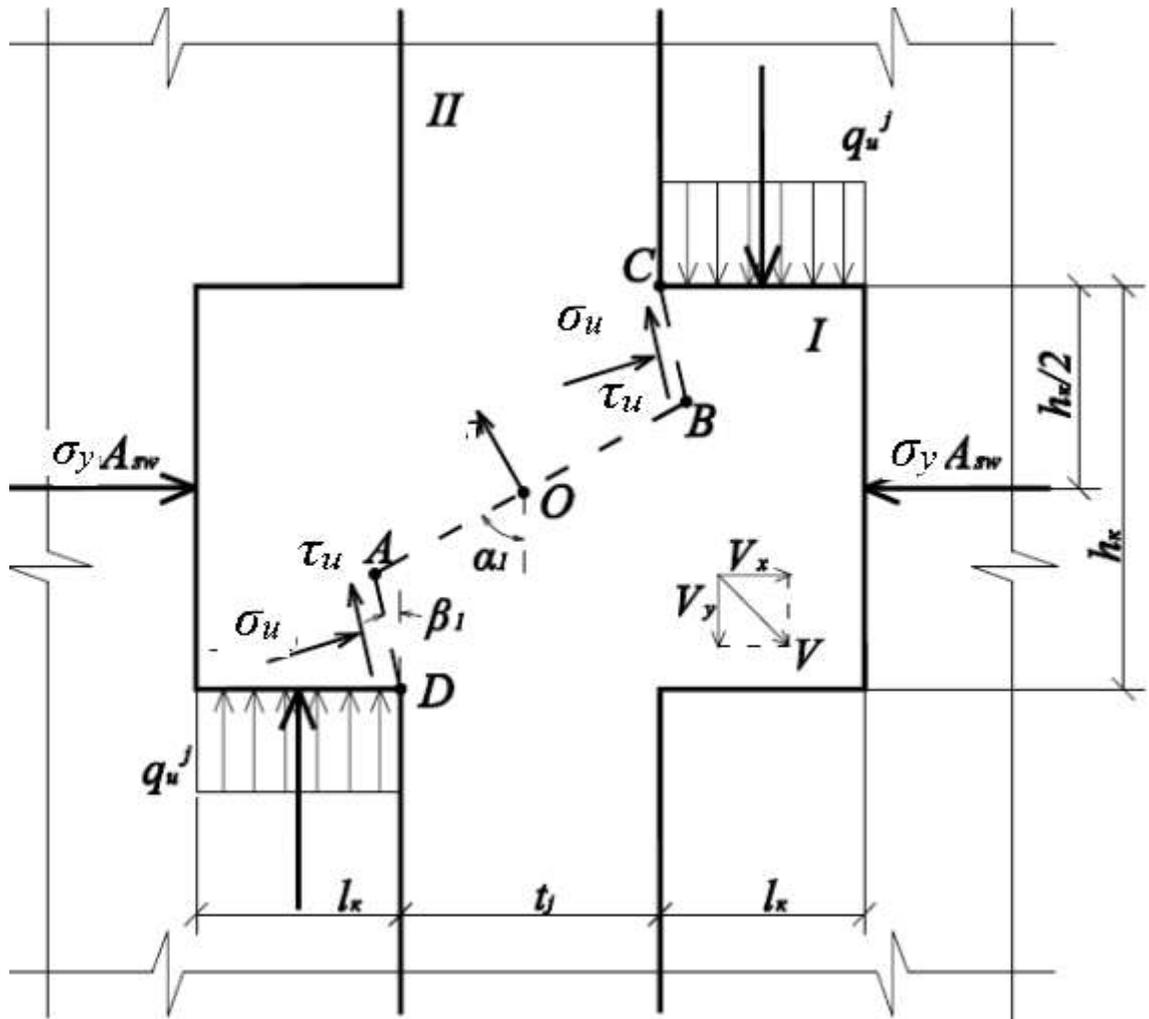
Кінематично можлива схема руйнування шва одношпонкових залізобетонних стиків з прямокутним профілем при розташуванні арматури в один рівень
